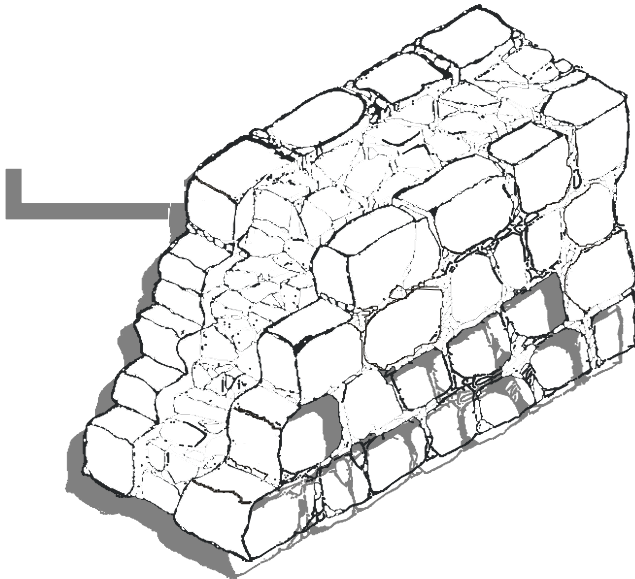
Muro de mampostería aparejada nucleada. Sistema posiblemente empleado en la construcción del templo de San Francisco
